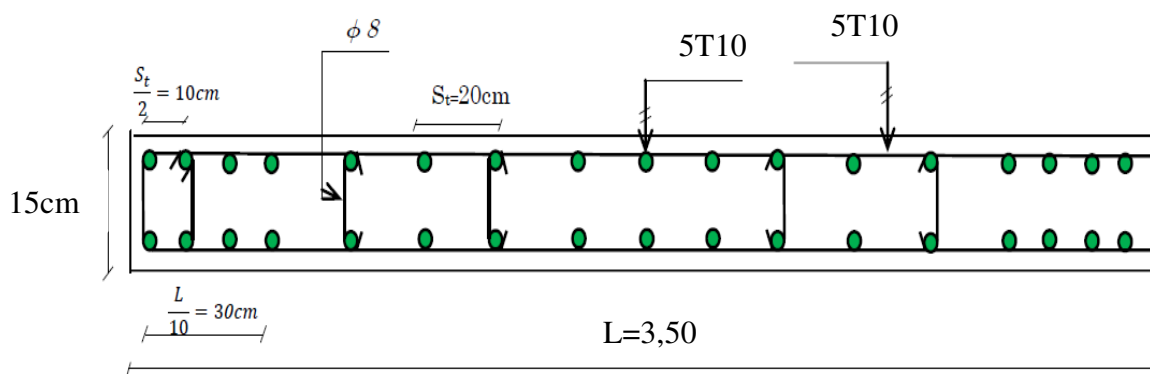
dispositions du ferrailage longitudinale du voile.
